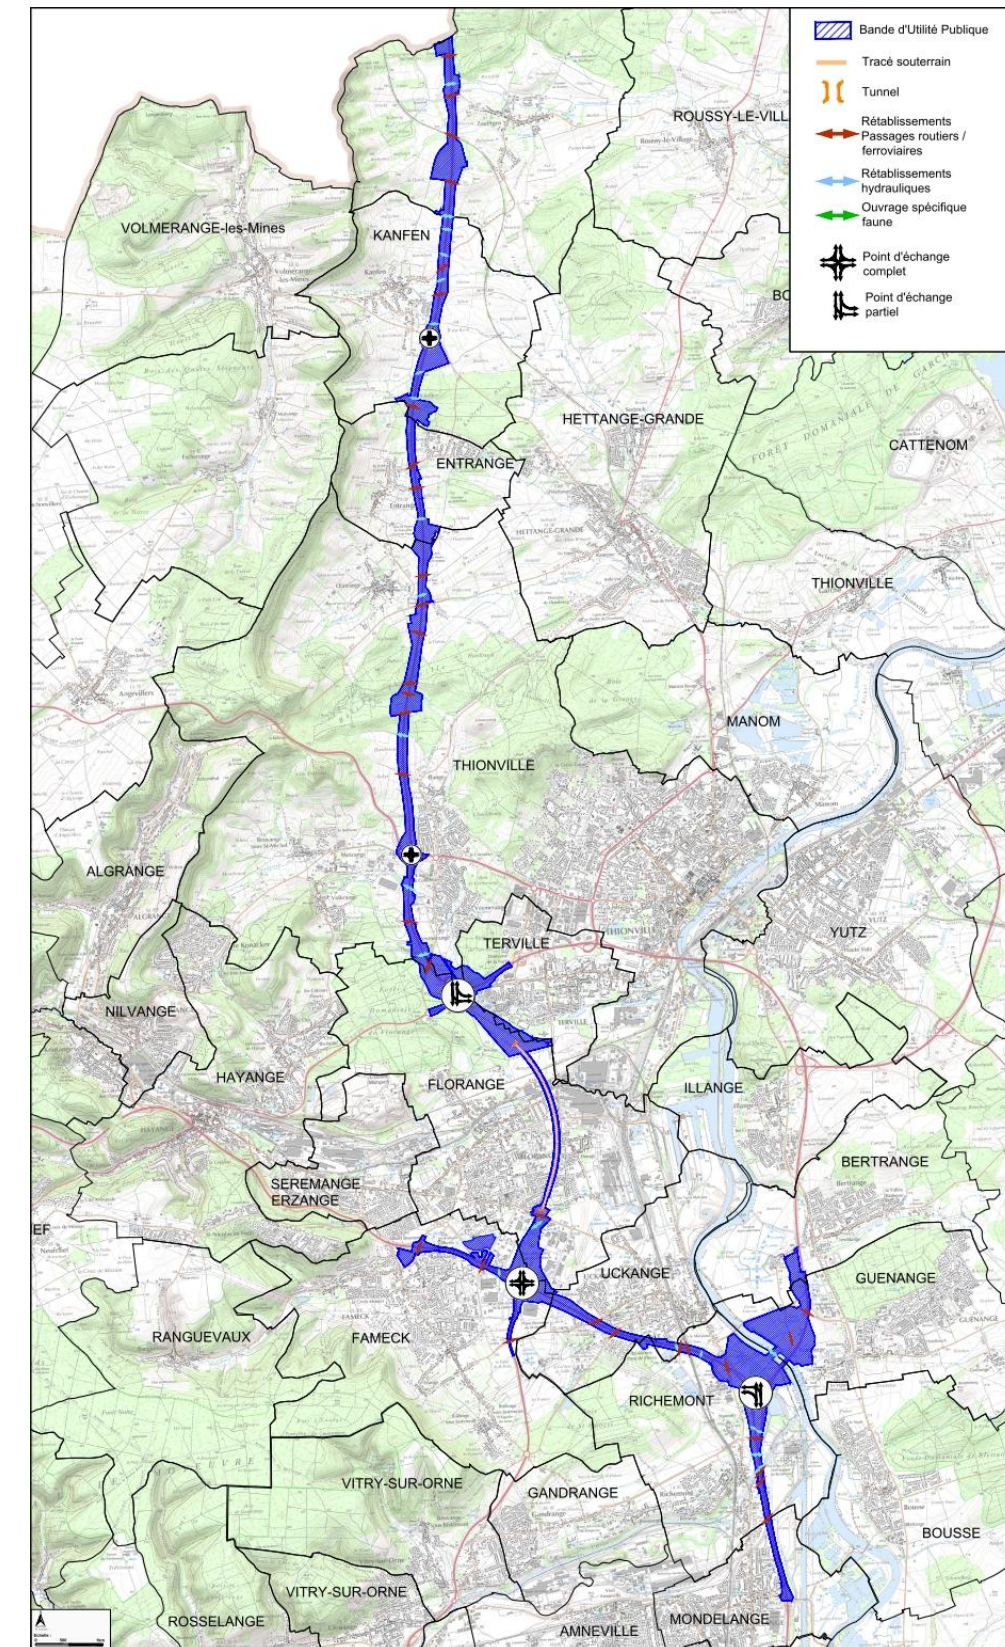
Plan général des travaux en secteur Nord du projet A31bis
